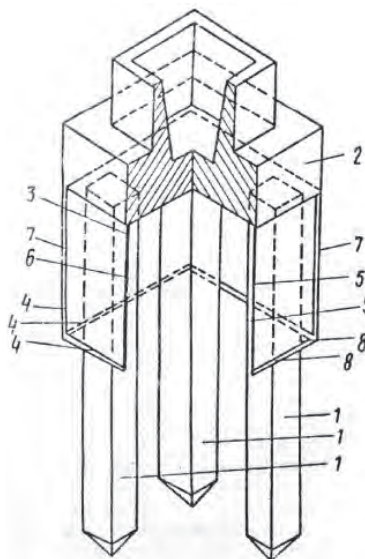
Конструкция свайного фундамента с ростверком в зоне промерзания
